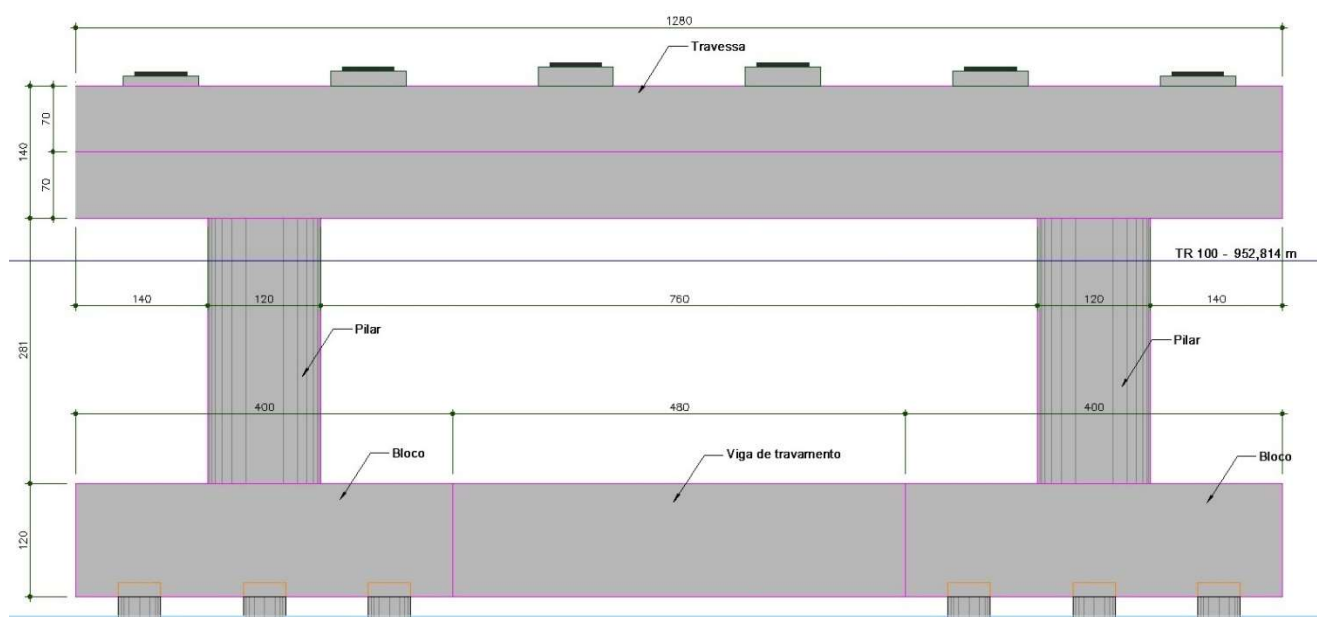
concepção da travessa e pilar central e seu pré-dimensionamento.
